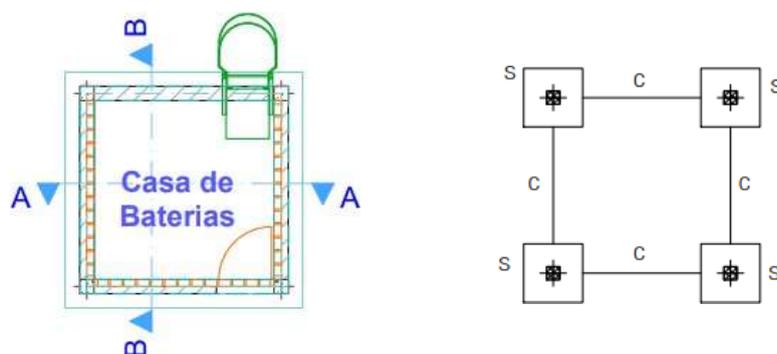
Planta arquitectónica e estrutural da casa de baterias (Fonte: Projecto do PAC).
